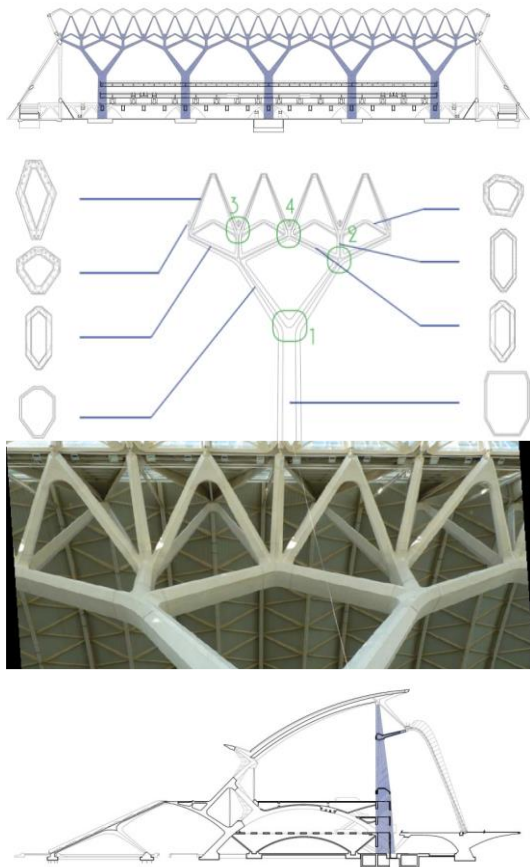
© Ángel Pascual Carrión Piles. Croquis y fotografía de El museo de ciencias del príncipe Felipe. Arriba: secciones y alzado de la estructura. Abajo Imagen de un detalle de la cubierta. Derecha: Detalle de los diferentes nodos para unir las barras de concreto. Obra realizada por el ingeniero Santiago Calatrava.
